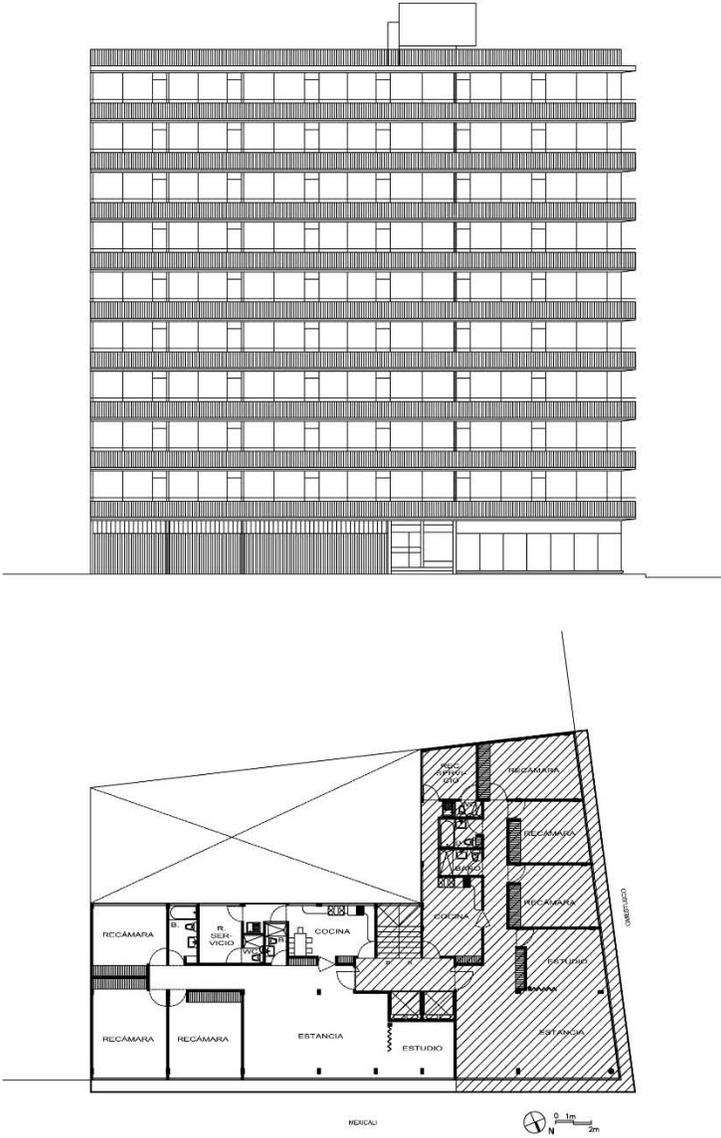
Fachada y planta del edificio ubicado en Mexicali núm. 20
